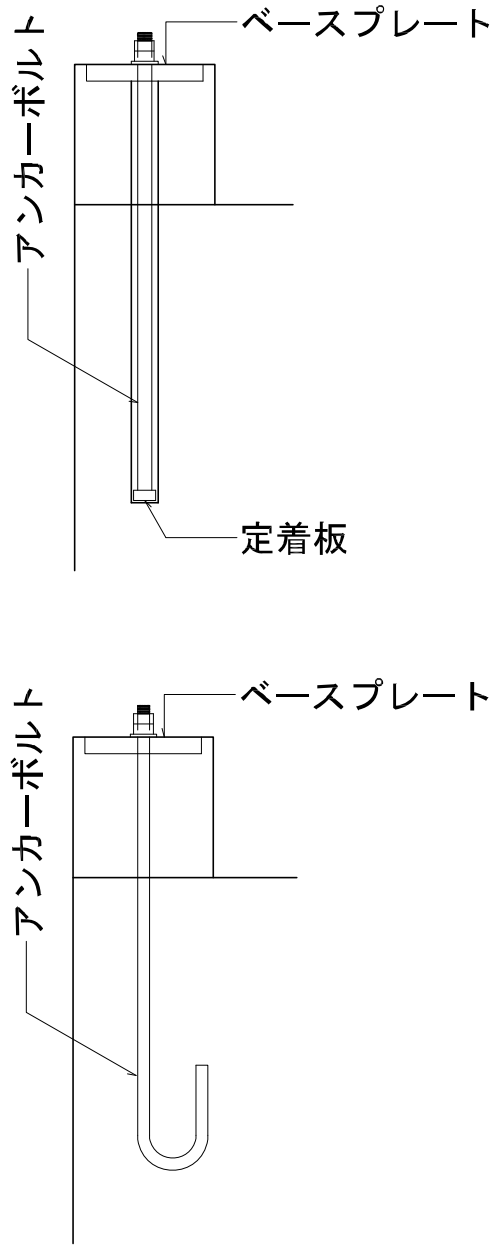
10 基礎ボルト断面図 (一般図, 上段: タイプ A, 下段: タイプ B)
